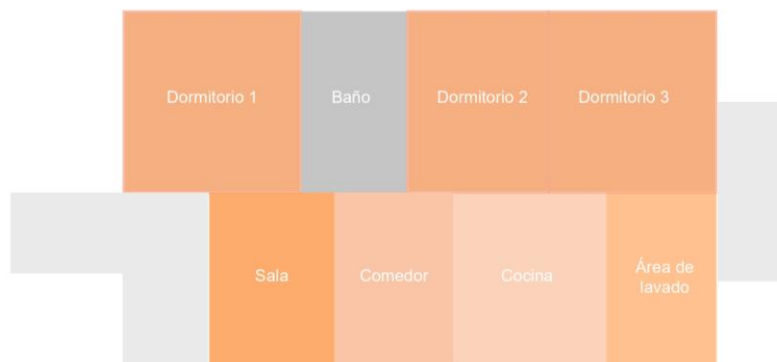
Croquis planta arquitectónica original 2 *Nota.* Elaboración propia a partir de caso de estudio.
